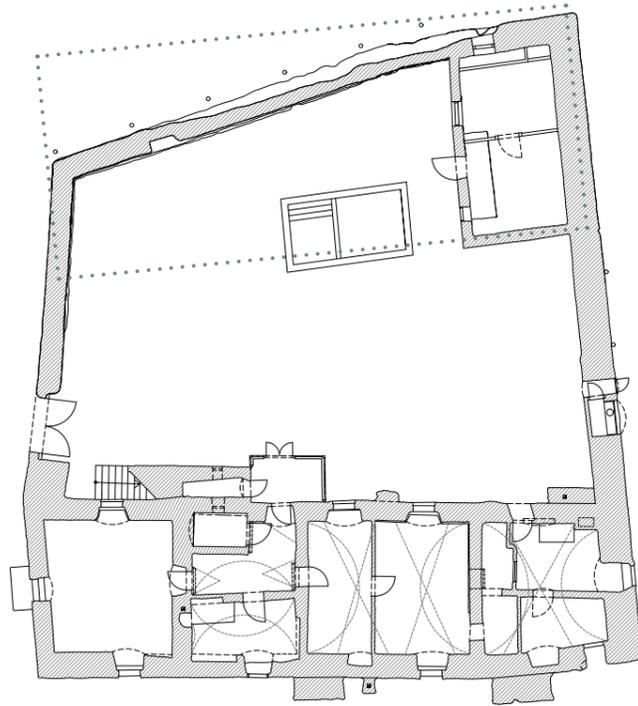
Lage Vorgängerbau, Grundriss Erdgeschoß
